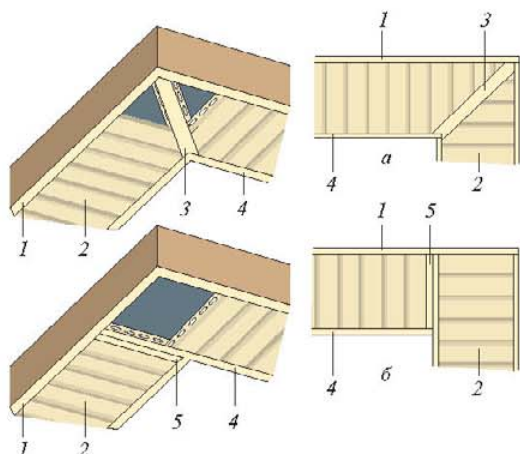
Соединение софитных подшивок на углах: а — на косой угол; б — на прямой угол; 1 — карнизный принимающий профиль; 2 — софит; 3 — Н-профиль или два J-профиля; 4 — пристенный принимающий профиль; 5 — J-профиль
